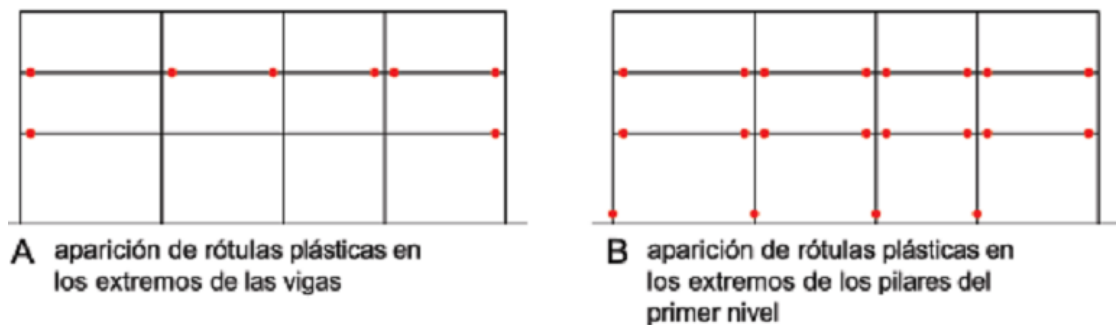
Estructura: A) Elástica hasta que aparecen las primeras rotulas plásticas en vigas.
